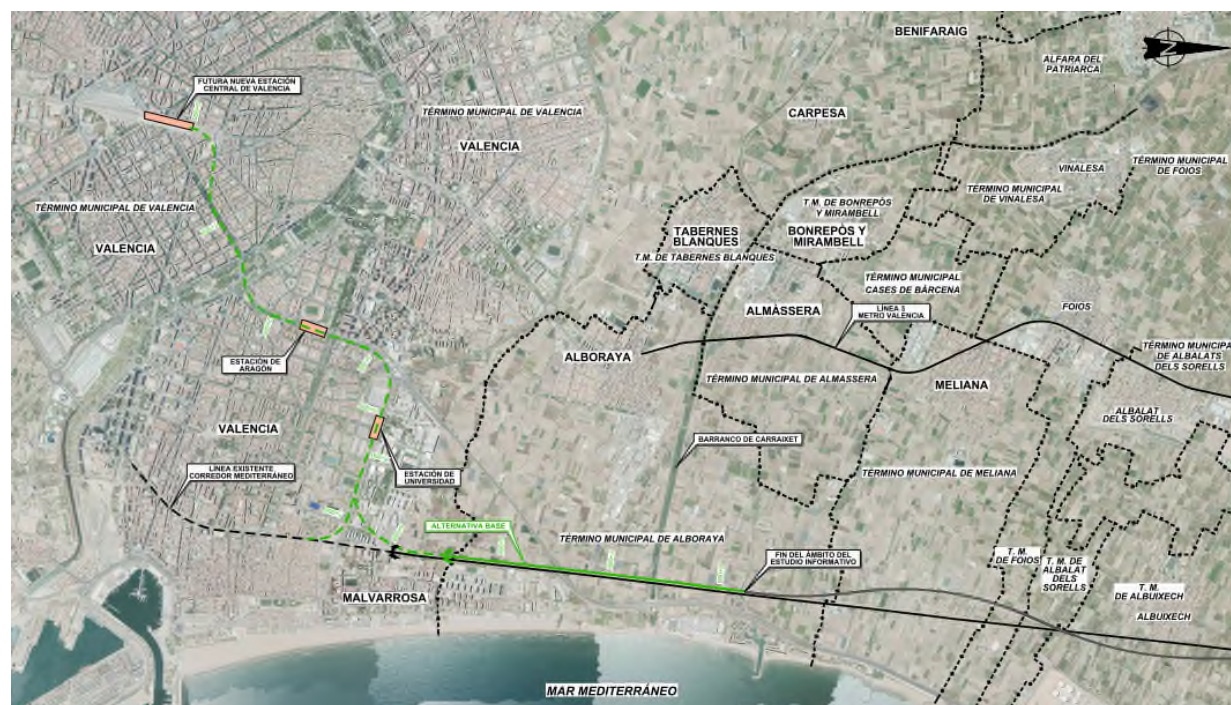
Alternativa Base. Fuente: Proyectos Constructivos Previos.
